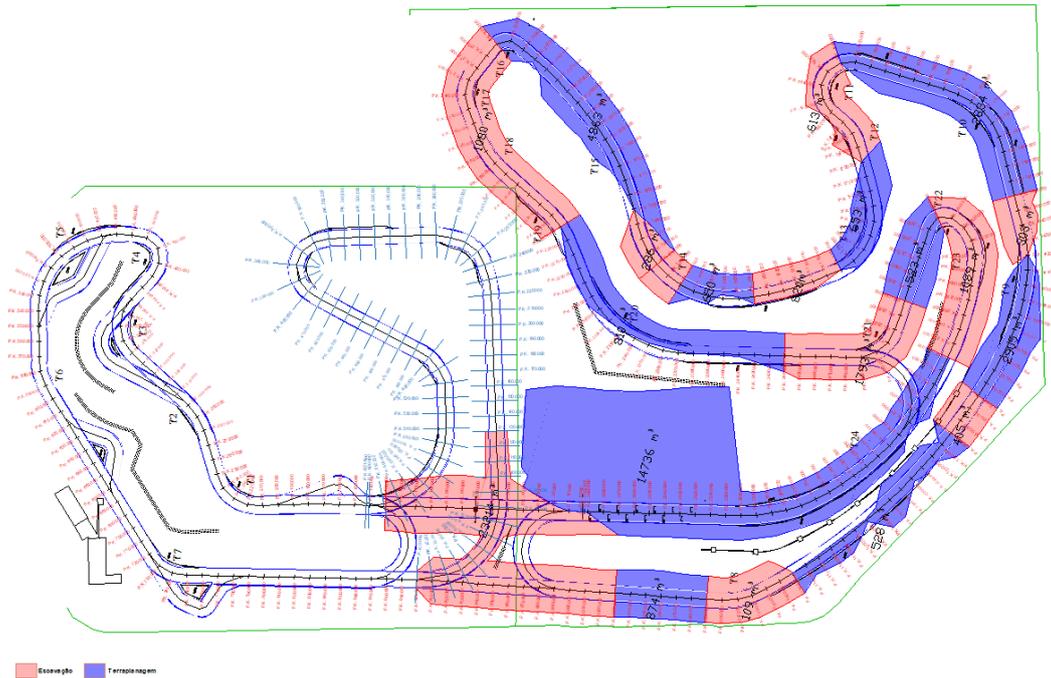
Terraplanagens e escavações a executar na zona de ampliação da pista
